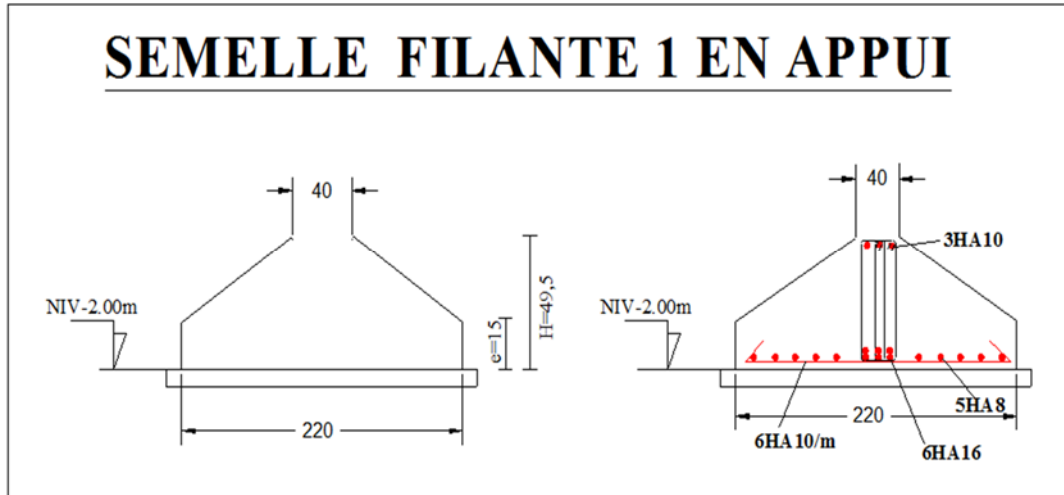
coupe en appuis et en travée da la semelle filante n°1
